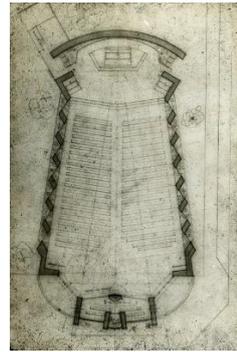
Dibujo del plano de la parroquia Santa Rosa de Lima, 1954-1964. Arquitecto Ricardo Salas.
